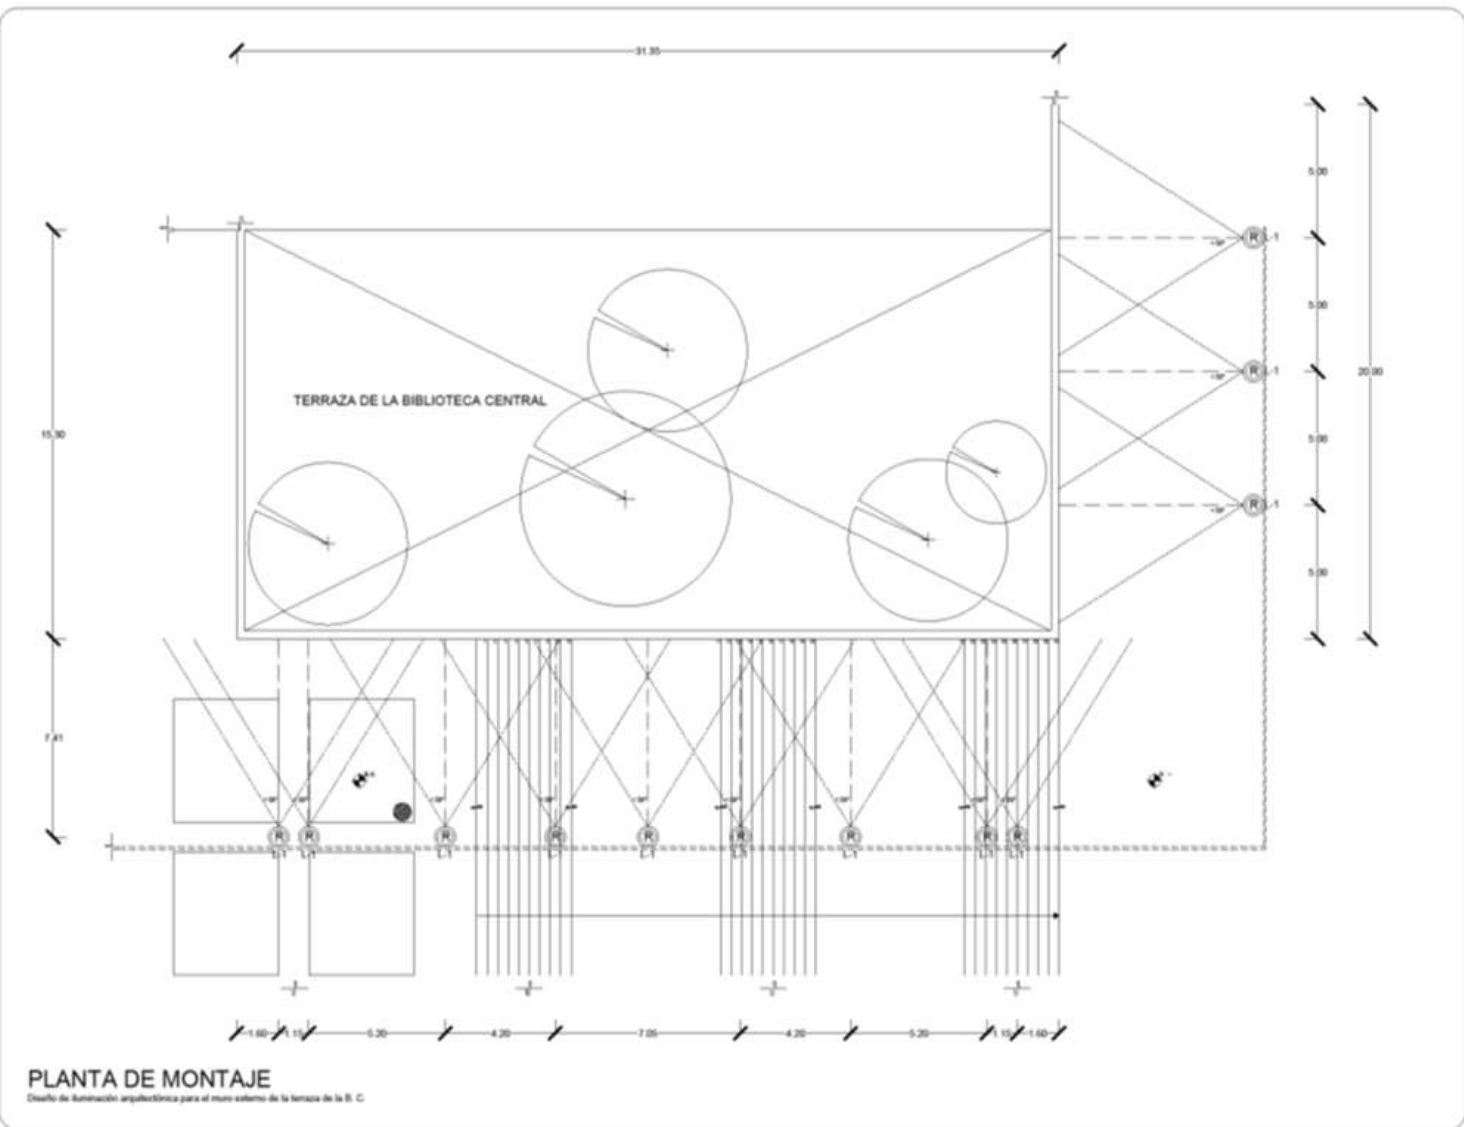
Planta de montaje muro de Querzalcóatl, GVHT.
